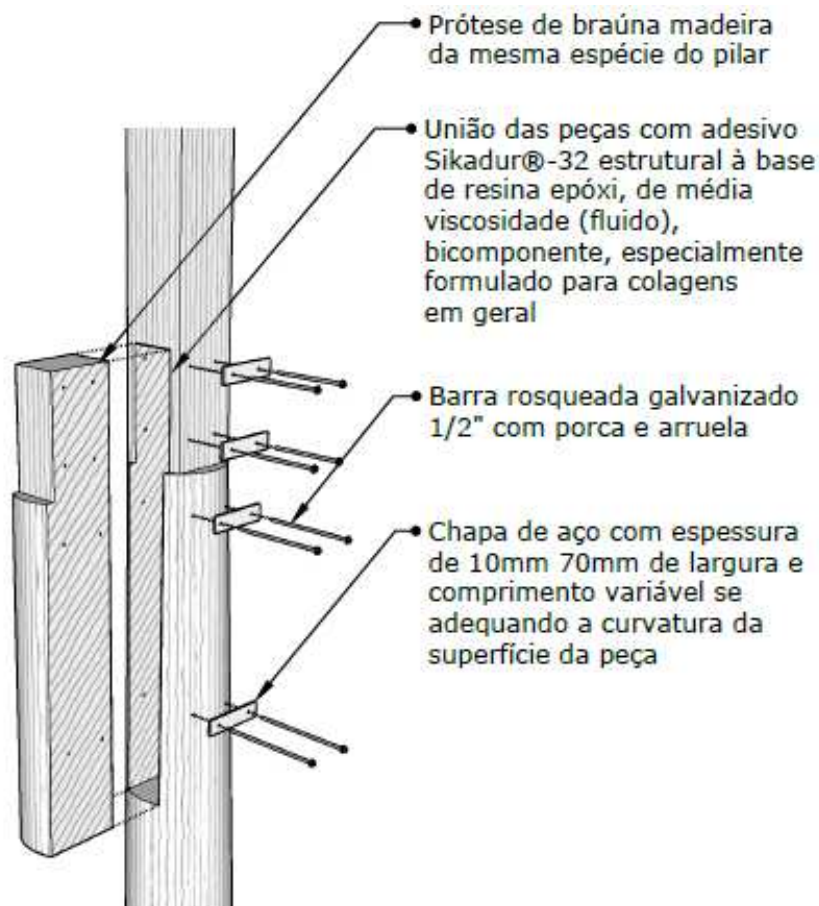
Detalhamento de reabilitação estrutural. Fonte: Projeto de Restauração
